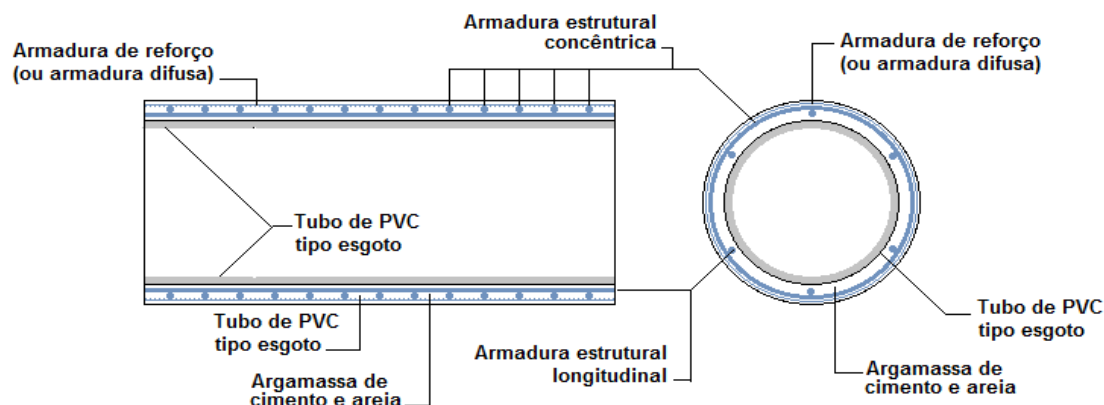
Esquema de armadura dos tubos de PVC reforçados com ferrocimento
